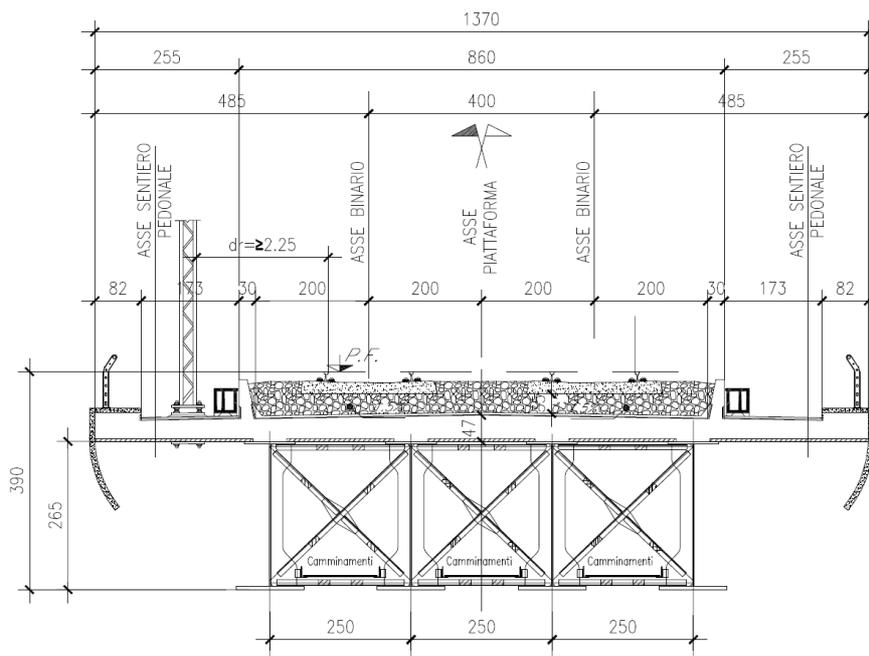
Impalcato in acciaio - cls L = 40 m: sezione trasversale
